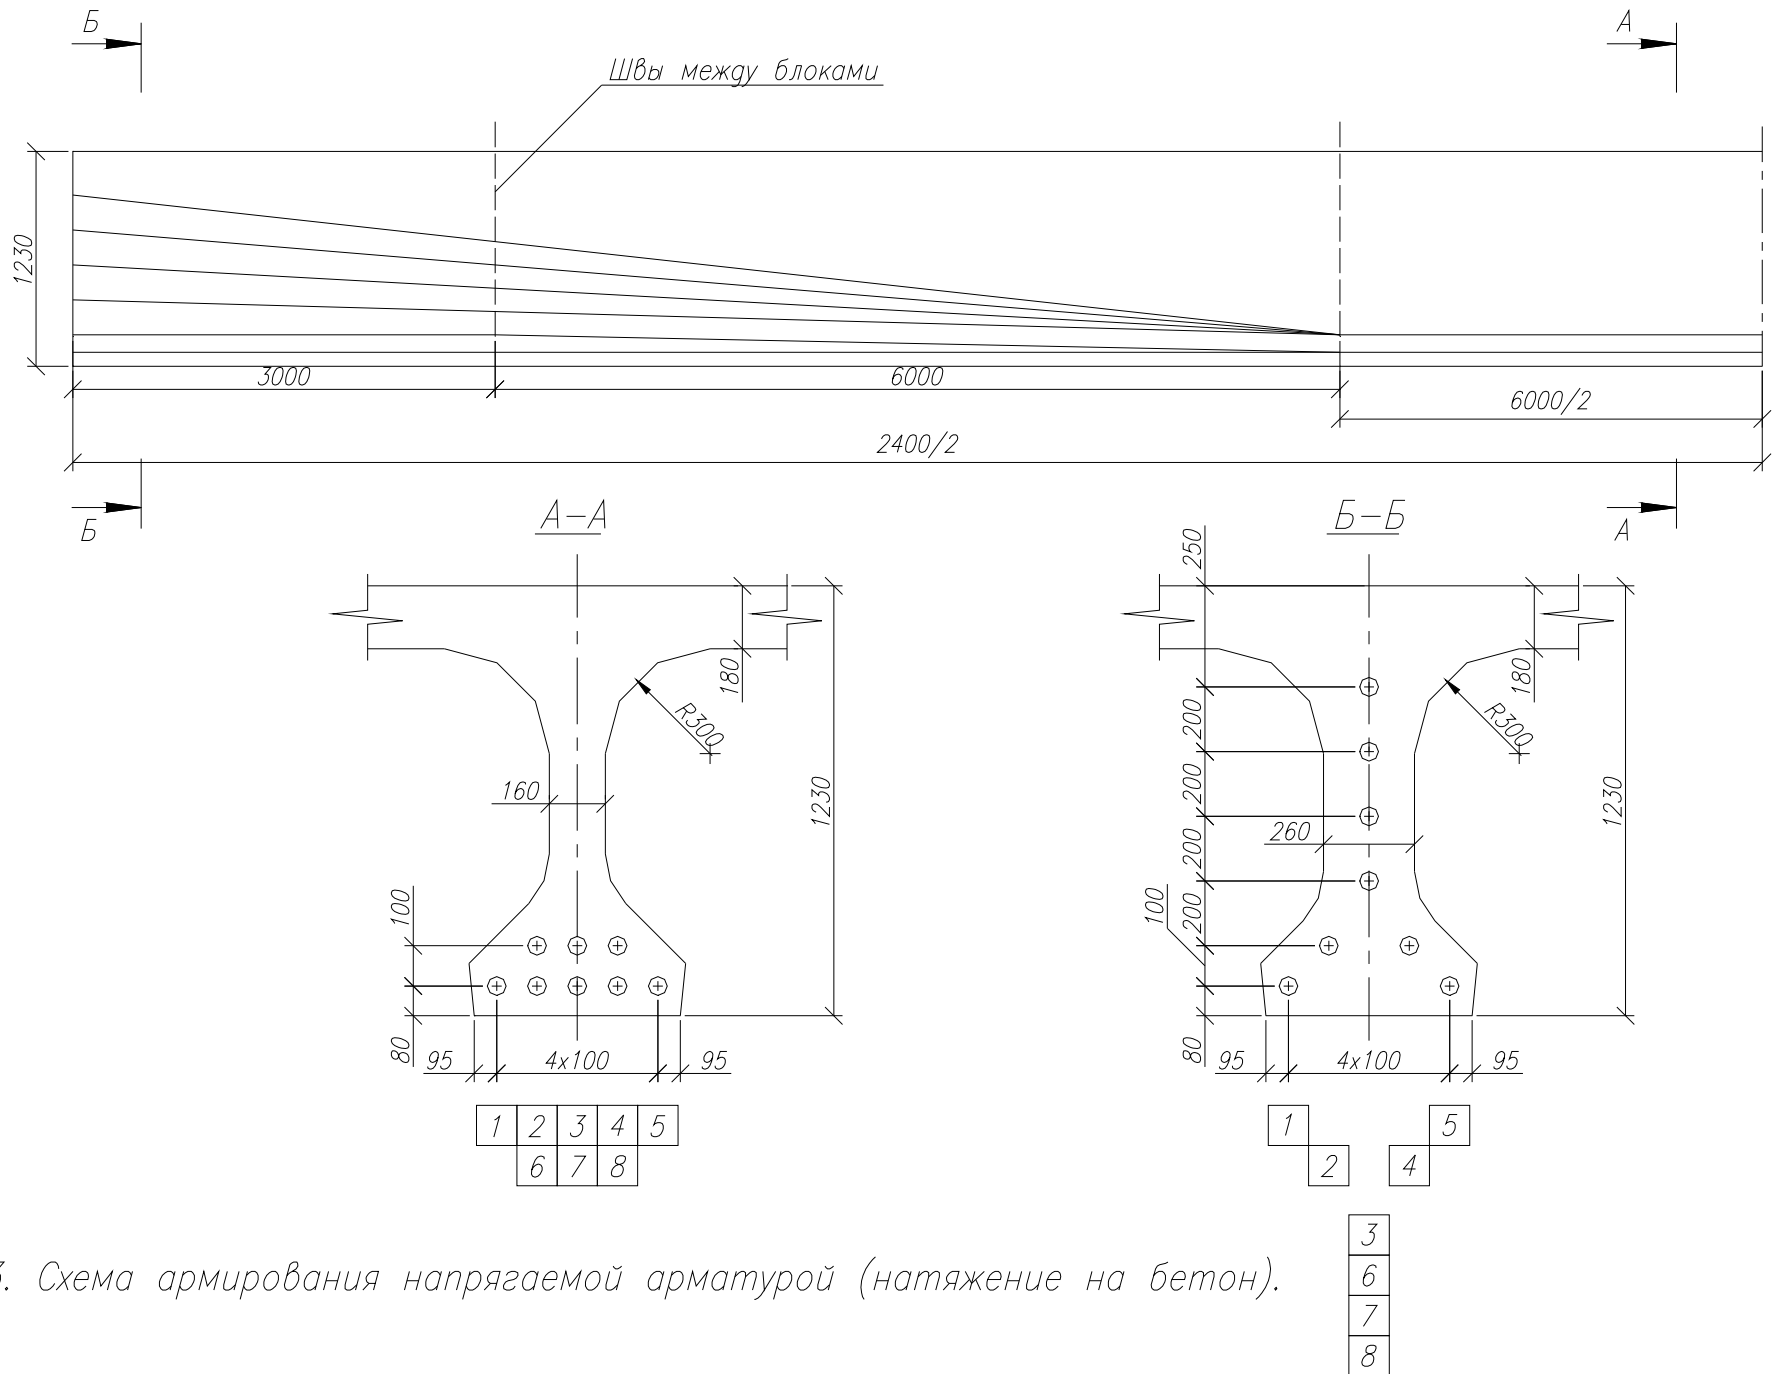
Схема армирования напрягаемой арматуры (натяжение на бетон).
